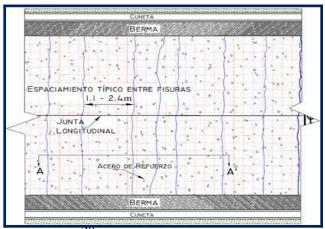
Vista típica del proceso constructivo de losas continuamente reforzada
